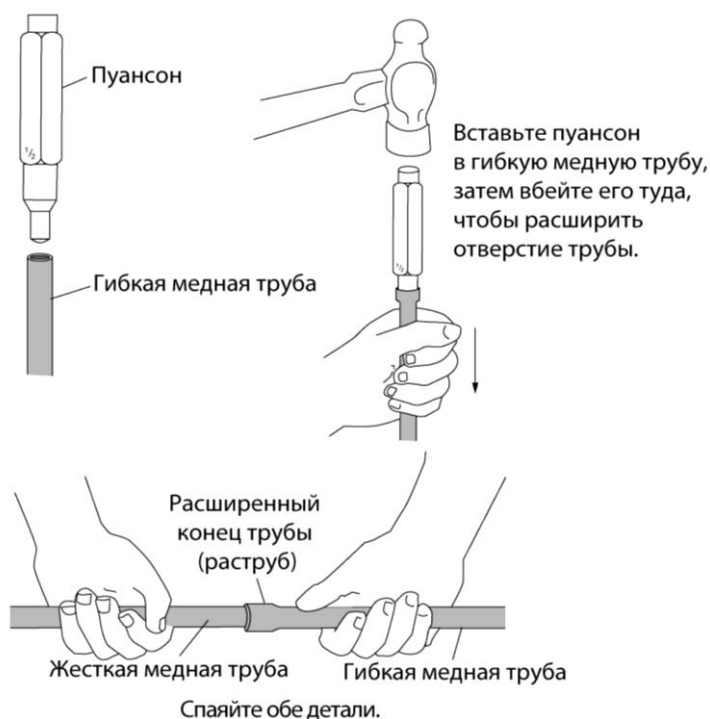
Использование специальных пуансонов для выполнения соединения гибких медных труб с жесткими
